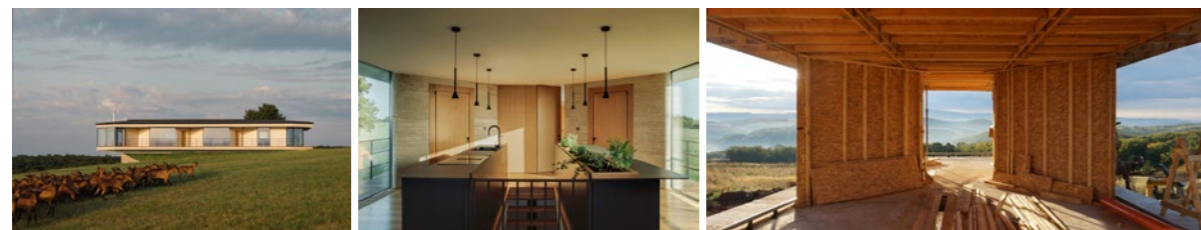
Hemp House a) Fachada; b) Interior; c) Processo de construção. Fonte: ArchDaily.
